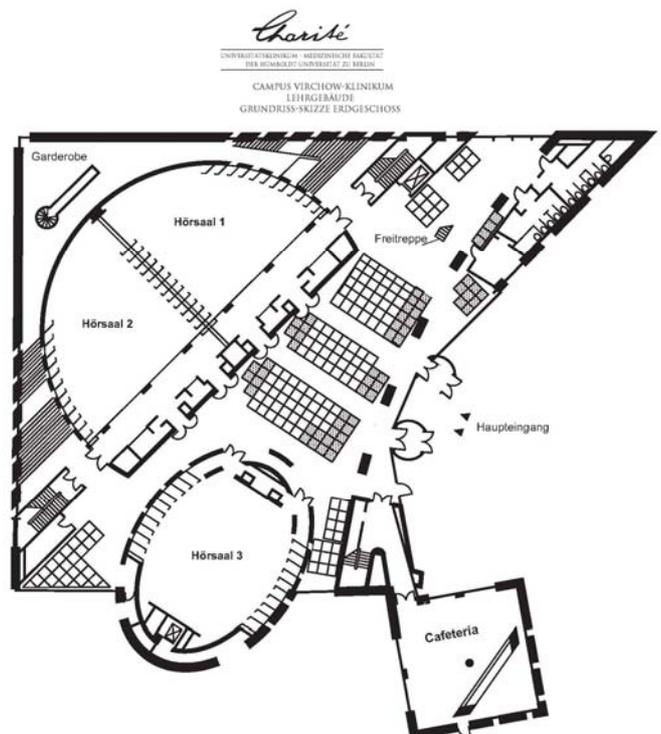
Grundriss der Hörsaal-Etage im Lehrgebäude, Campus Virchow, Tagungsstätte der TELEMED 2004-05
